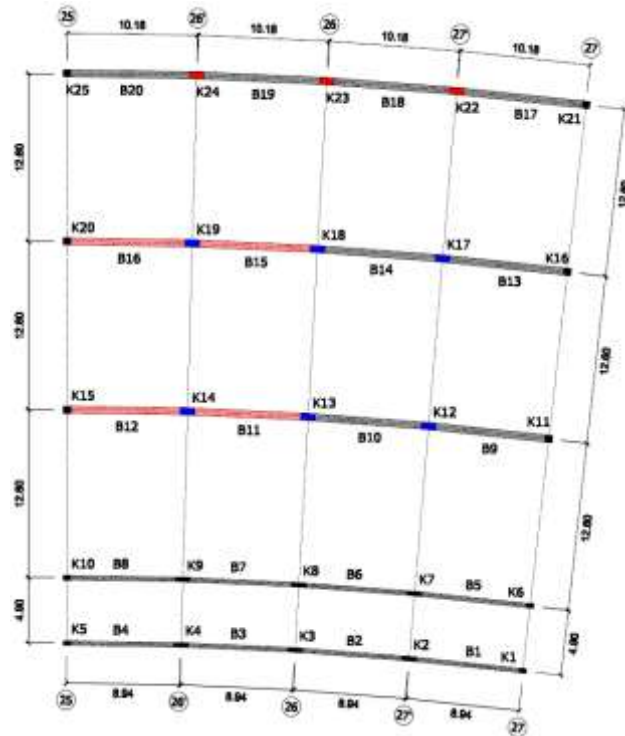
Lokasi Balok dan Kolom Terminal 1A Lantai 1 Sebelah Kanan
